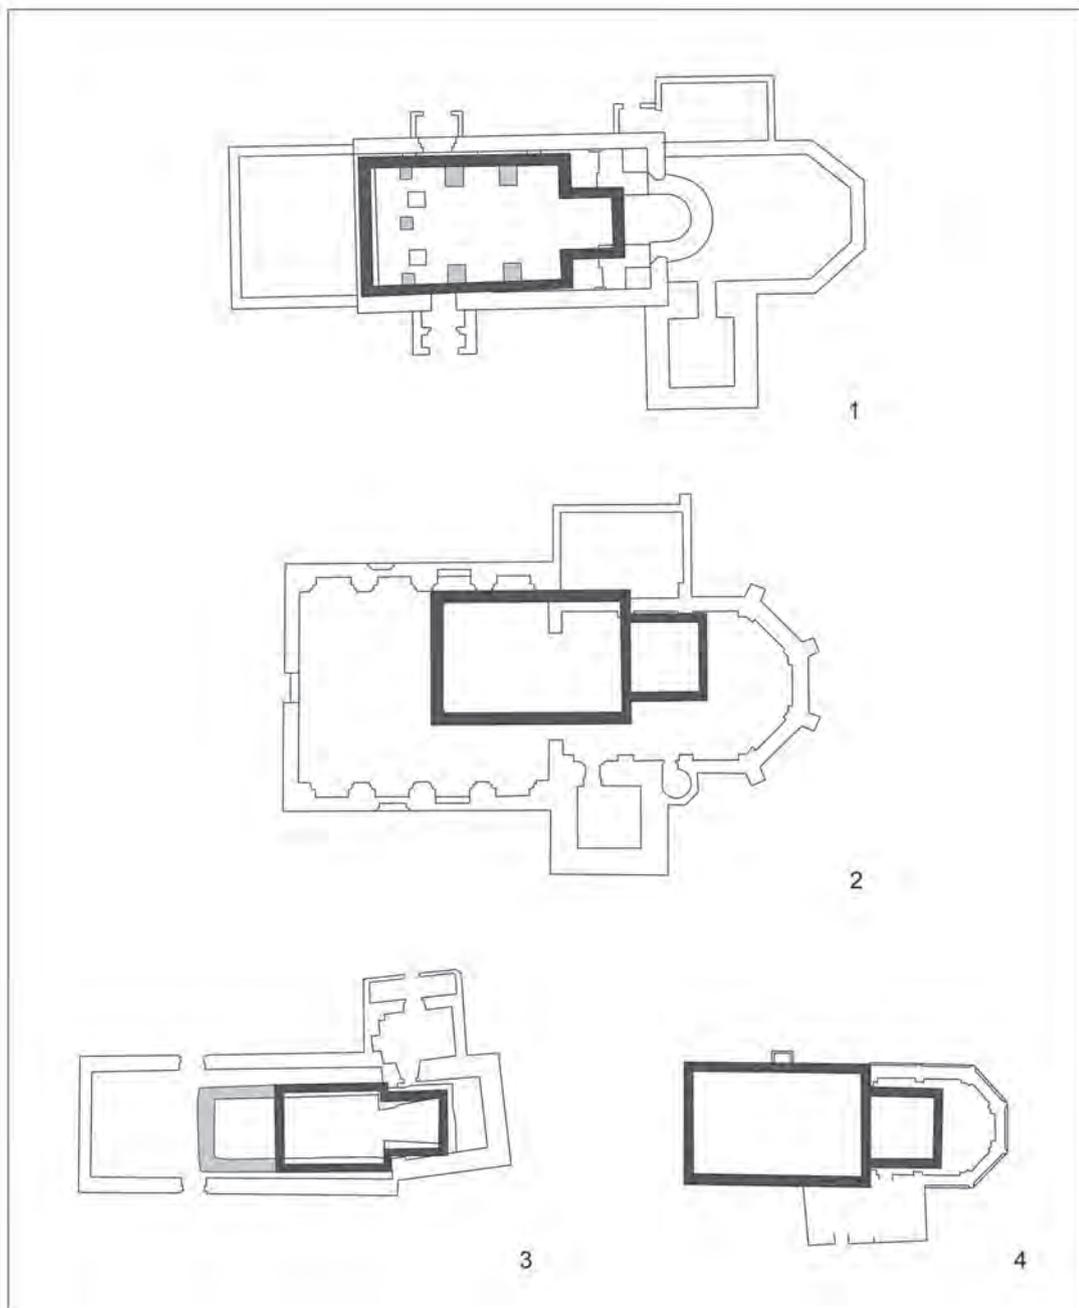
Grundrisse steinerner Kirchen mit Rechteckchor: 1 – Herrnwahlthann, 2 – Westen, 3 – Sinzing, 4 – Oberlindhart. Alle Grundrisse genordet. M. 1:400 (Plan R. Röhl).
